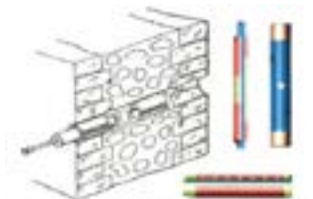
Echipamentul Dilatometru – (foto -João Ferreira)
